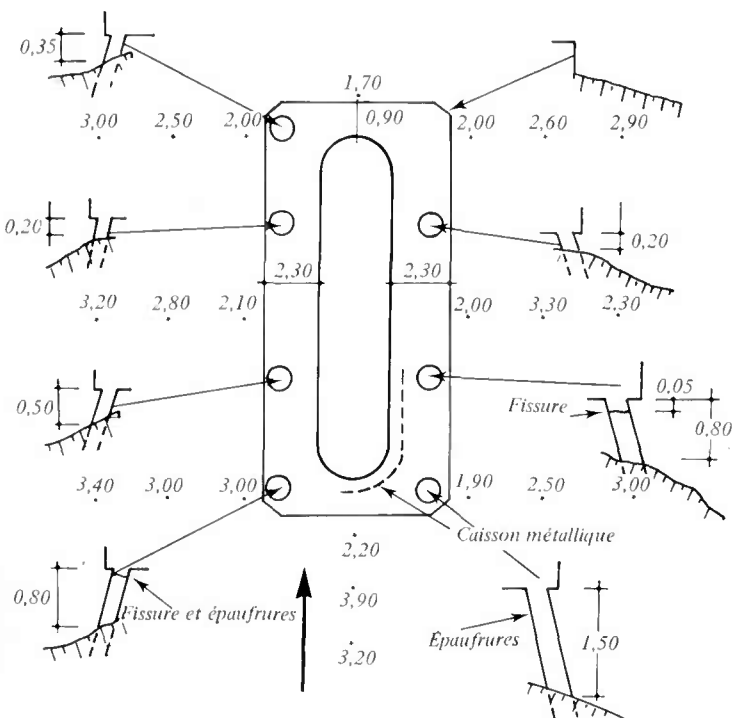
Affouillement d'un ouvrage moderne fondé sur pieux en béton armé. Noter les fissures de certains pieux dégarnis.
